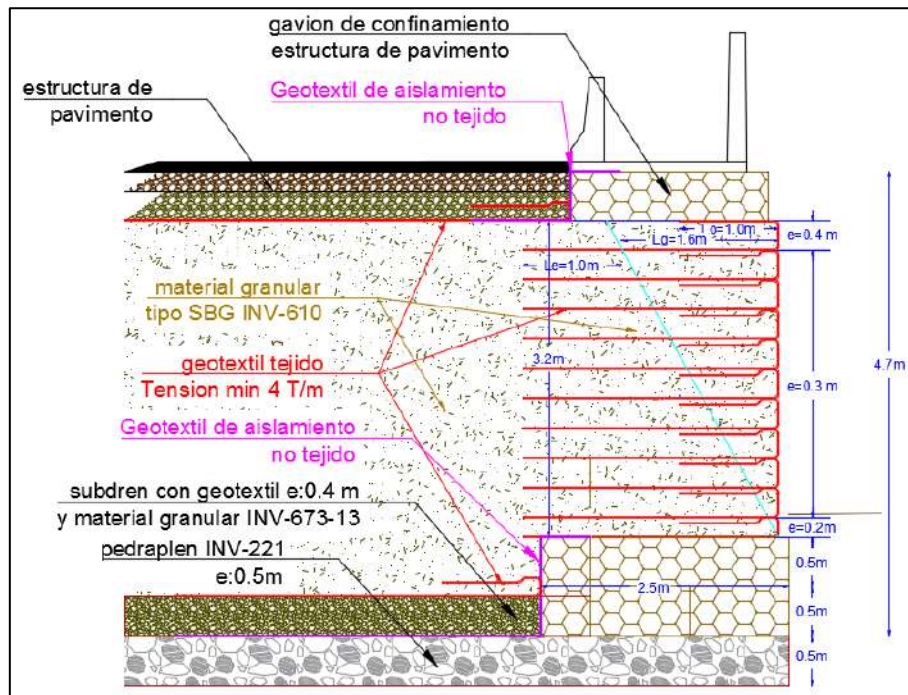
Esquematzación Muro Mecánicamente Estabilizado Terraplén Estribo 2
